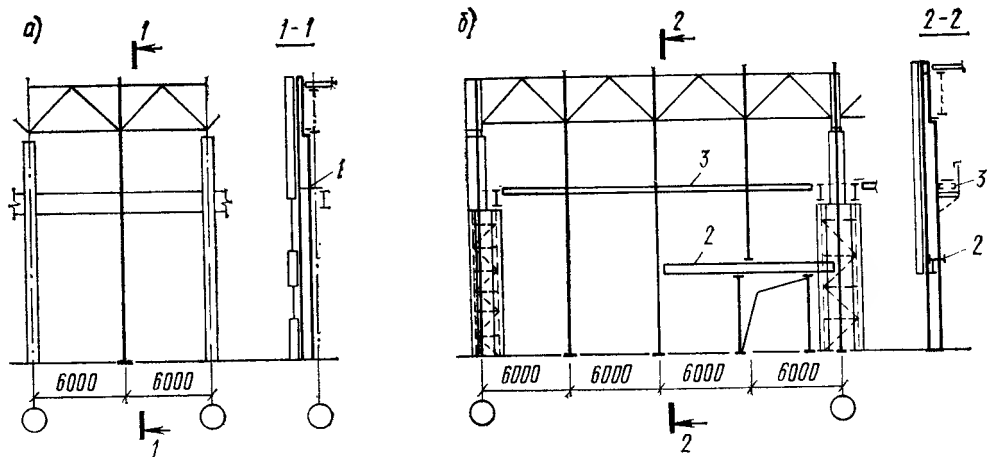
Схемы фахверка наружных стен из легковесных панелей и каркасных металлических трехслойных панелей
